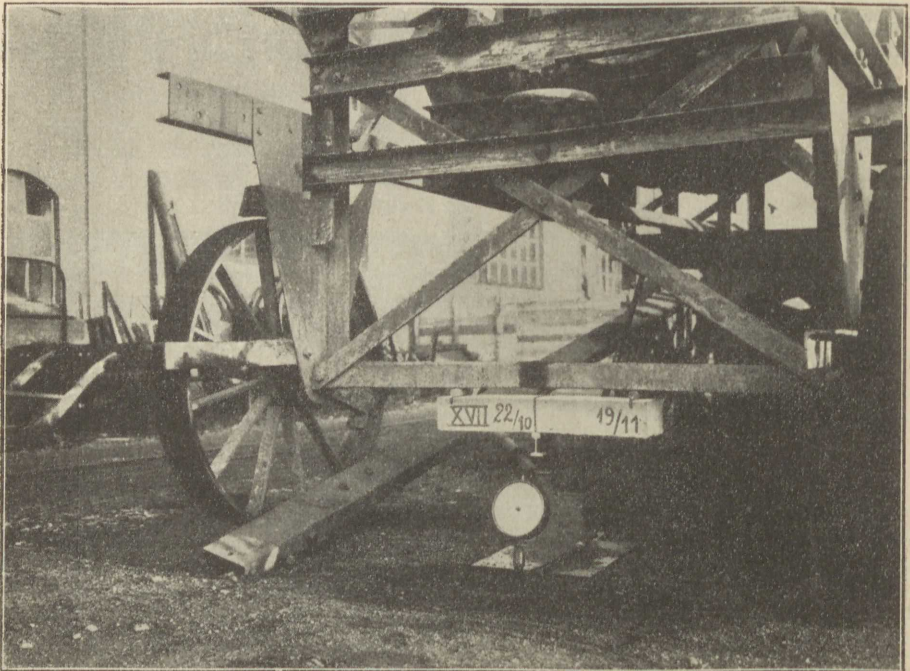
Prüfung unbewehrter Betonbalken zur Bestimmung der Zugfestigkeit des Betons bei Biegung.
